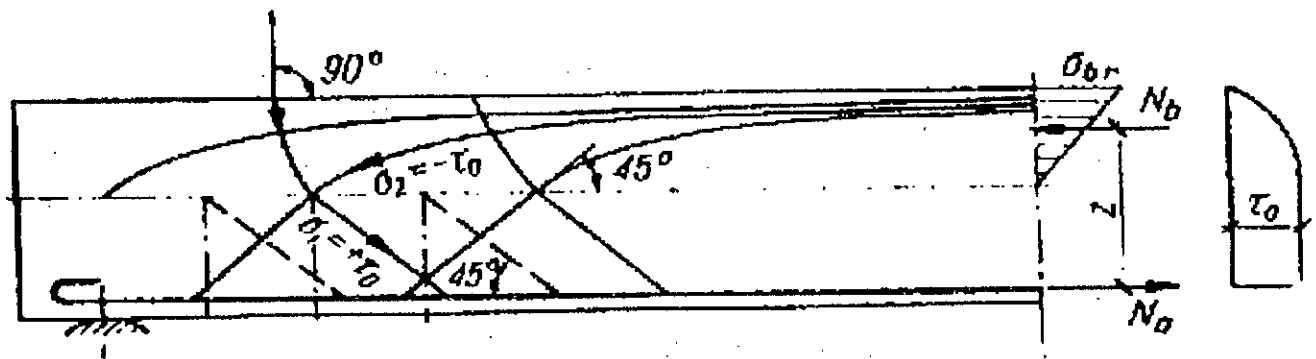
Disposition idéale des lignes de forces des contraintes principales dans une poutre fissurée en béton armé.
